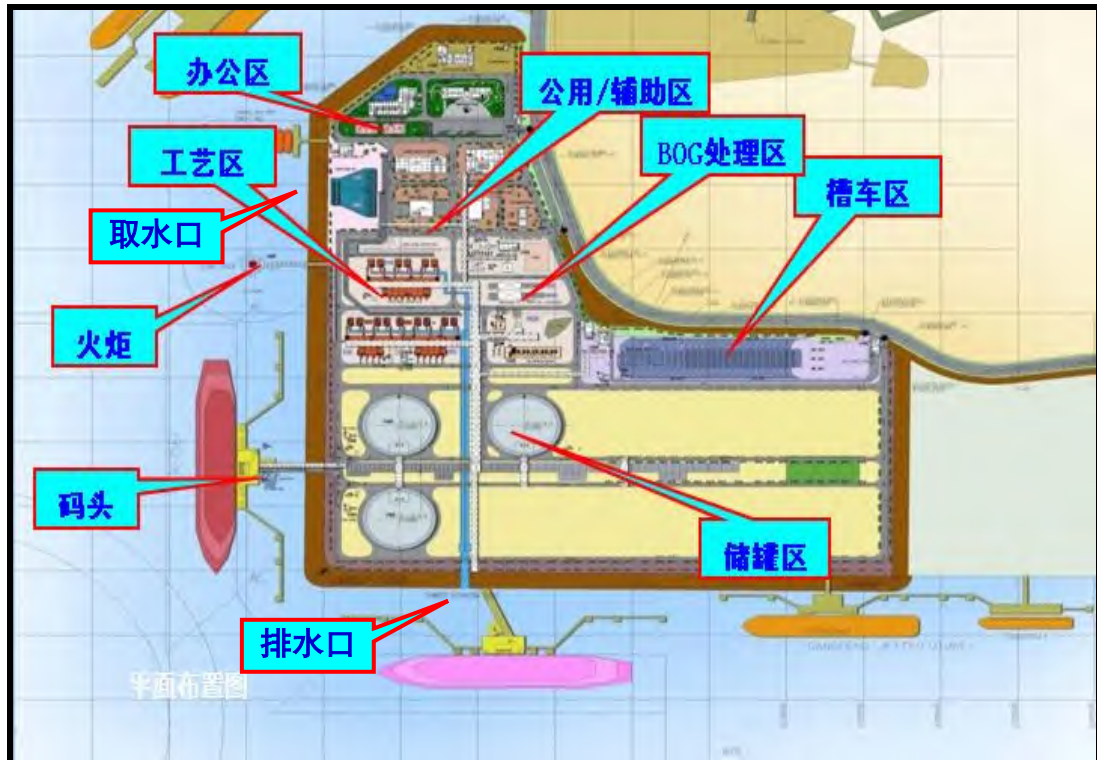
广东珠海 LNG 项目接收站及码头平面布置图
